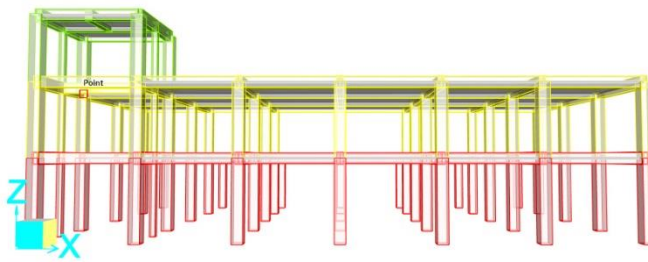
Denah Model Struktur Rumah Sakit L3
